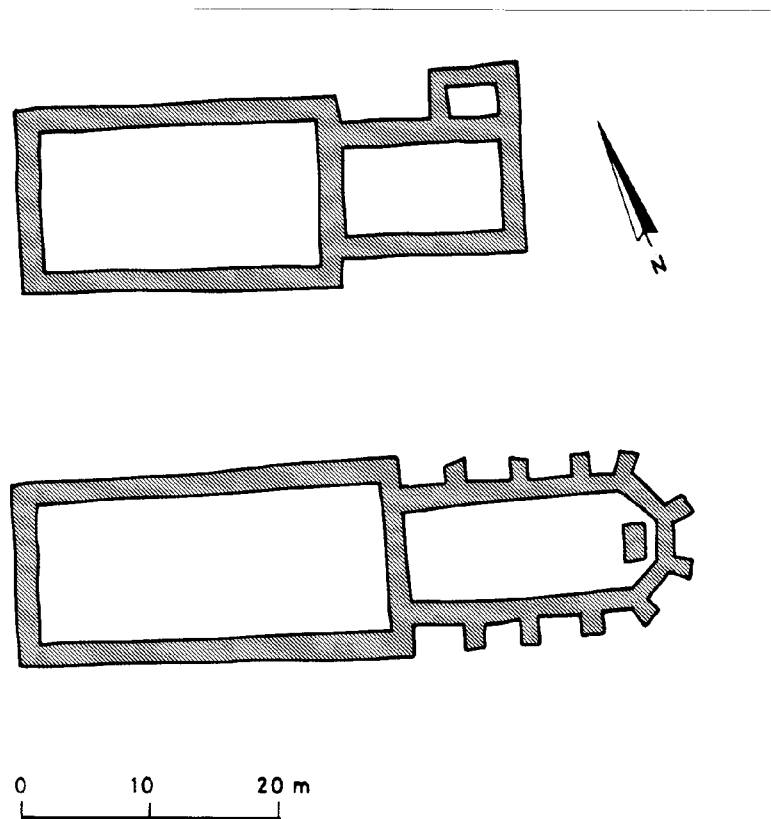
Ulm, Barfüßerkirche: Bau I (um 1250); Bau II (um 1300); Fundament-Grundrisse.
